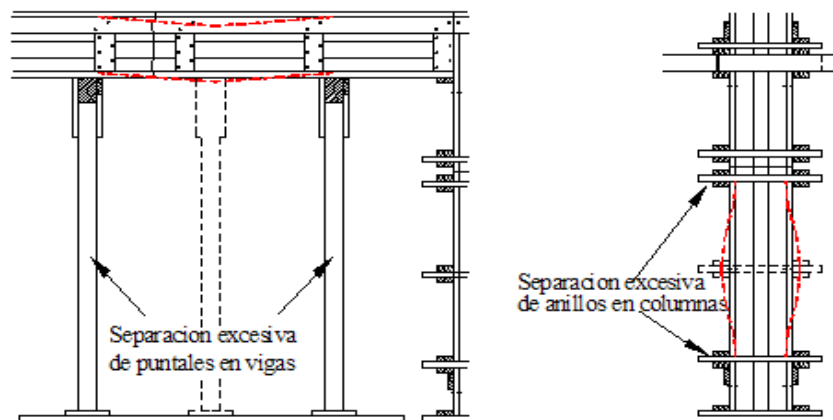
Fallas por diseño inadecuado de los encofrados
